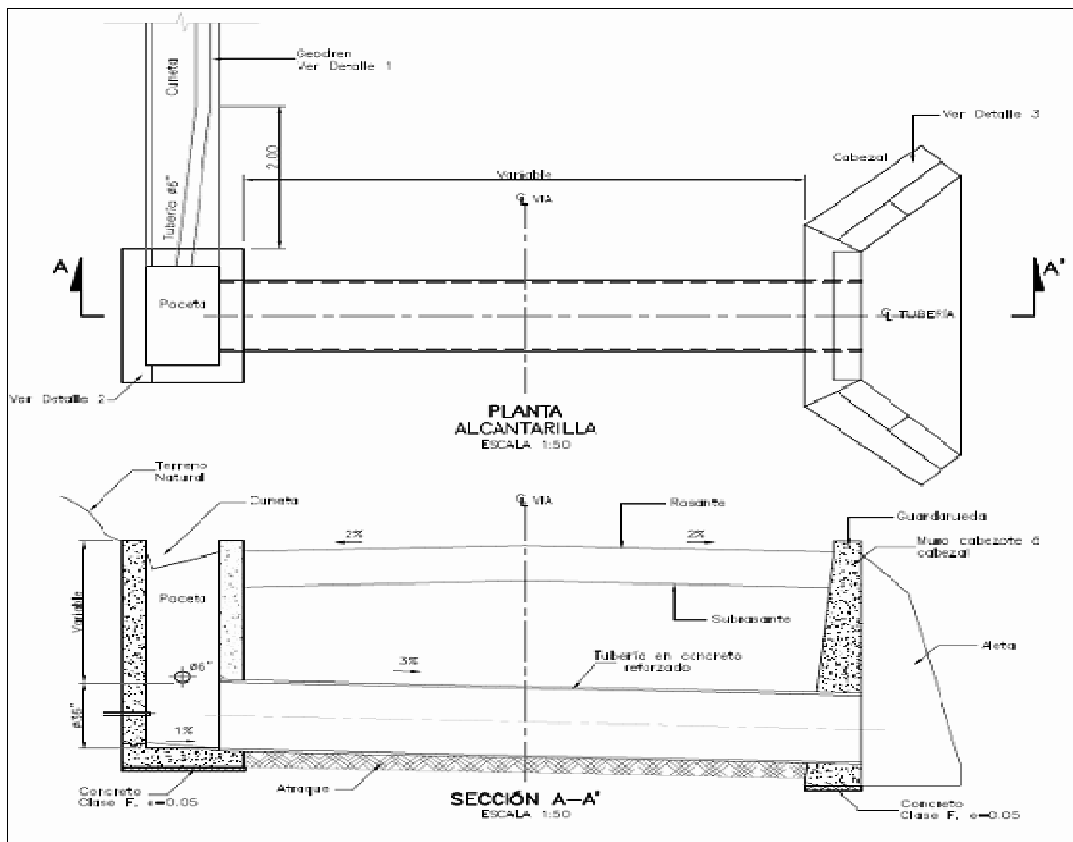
Diseño tipo de alcantarillas a utilizar
